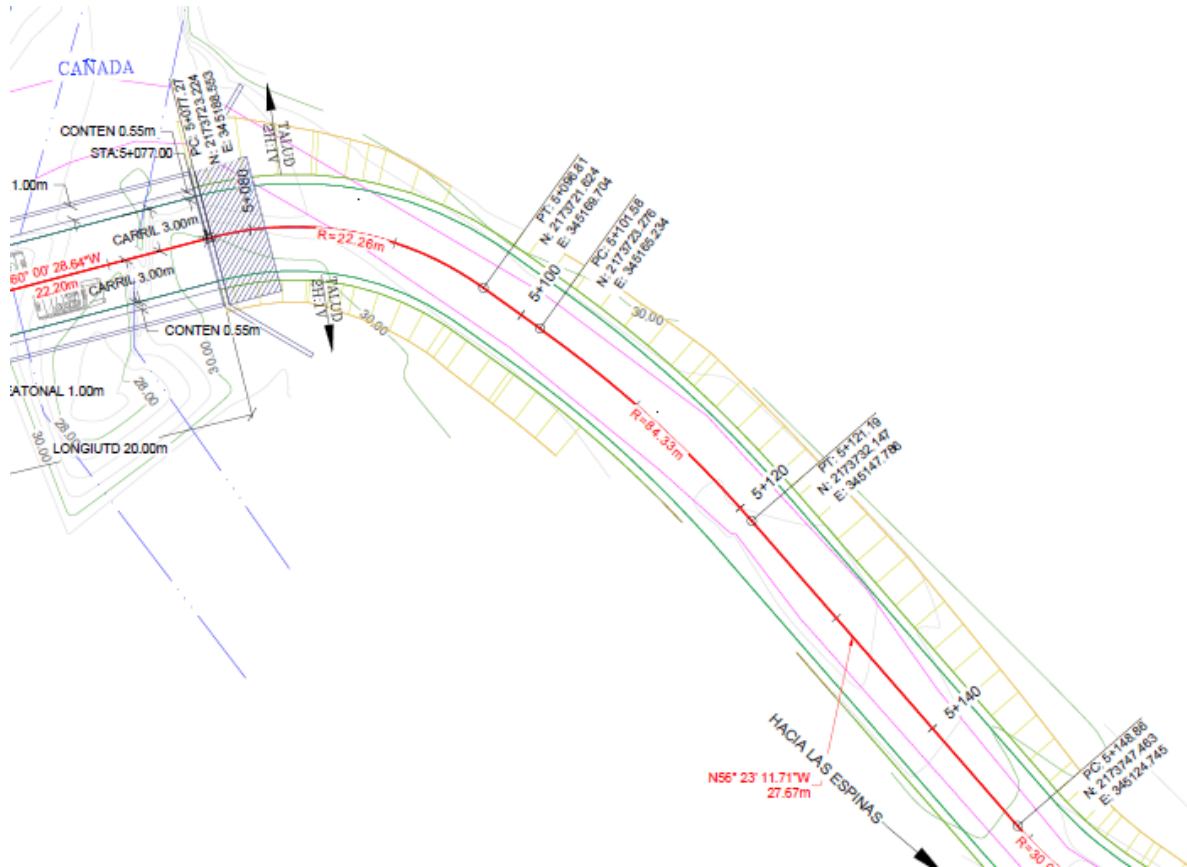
Planta y elevación del tramo de acceso al puente sobre la Quebrada sin nombre
